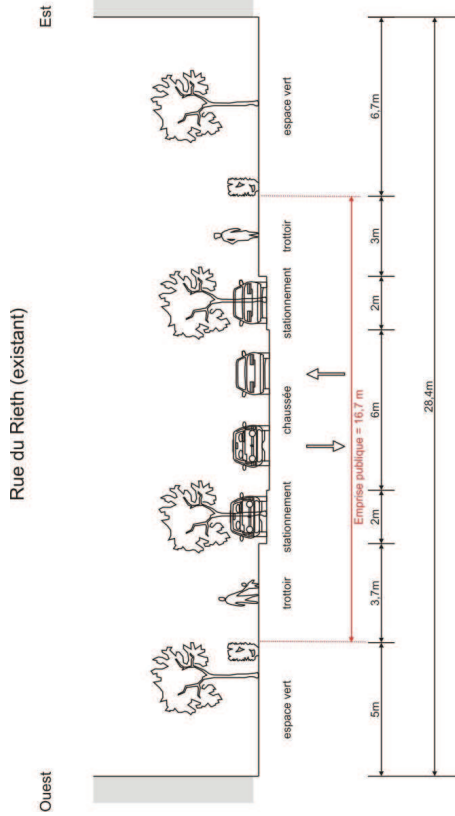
Situation existante. Coupe d'insertion sur la rue du Rieth
